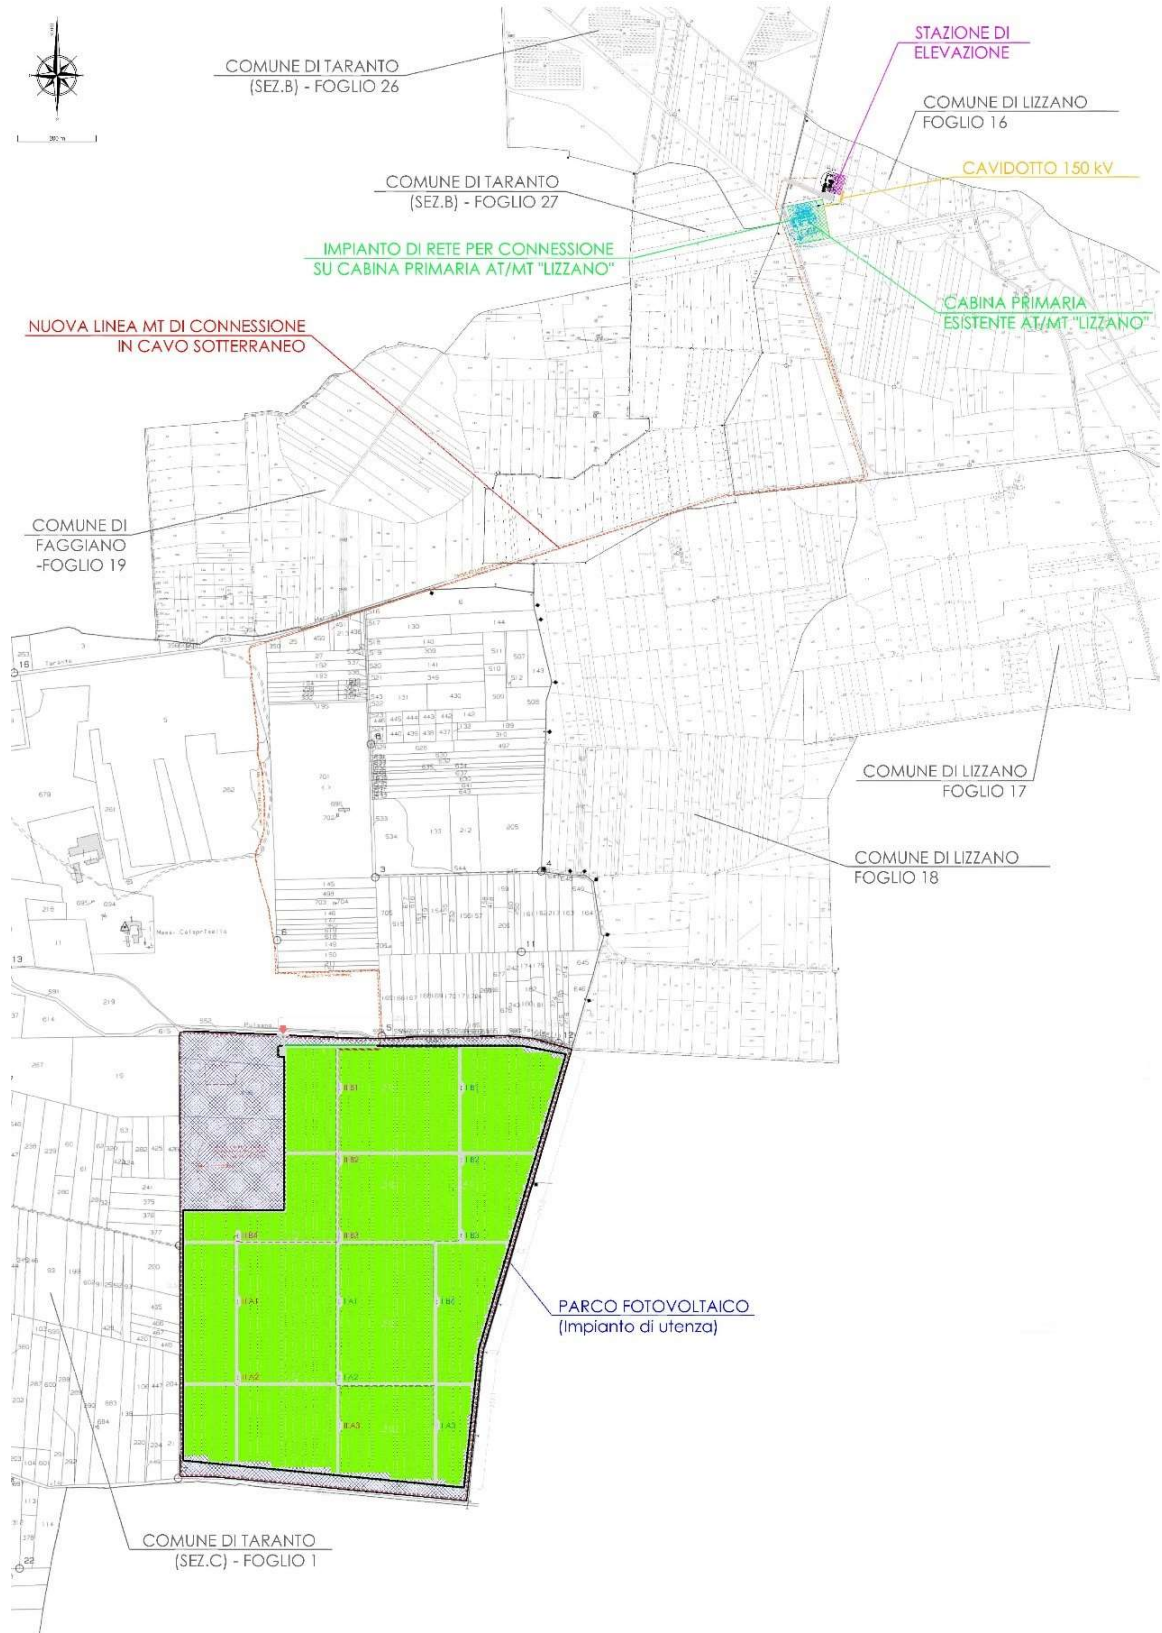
Inquadramento generale dell'opera su planimetria catastale
